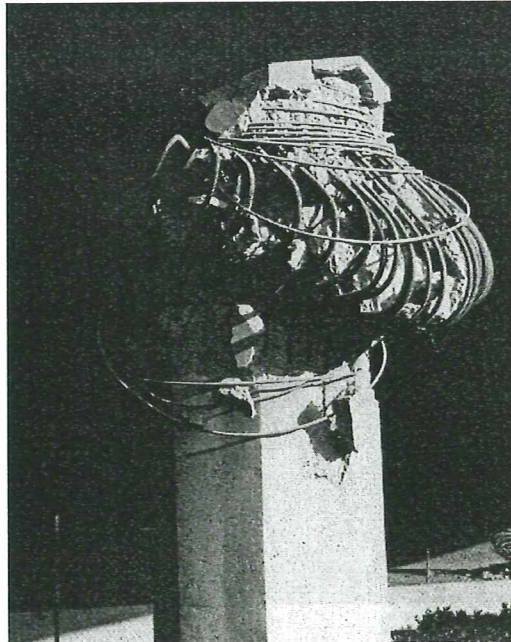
Fallo de la columna sur de la pila número dos, (Priestley *et al.*, 1994).
